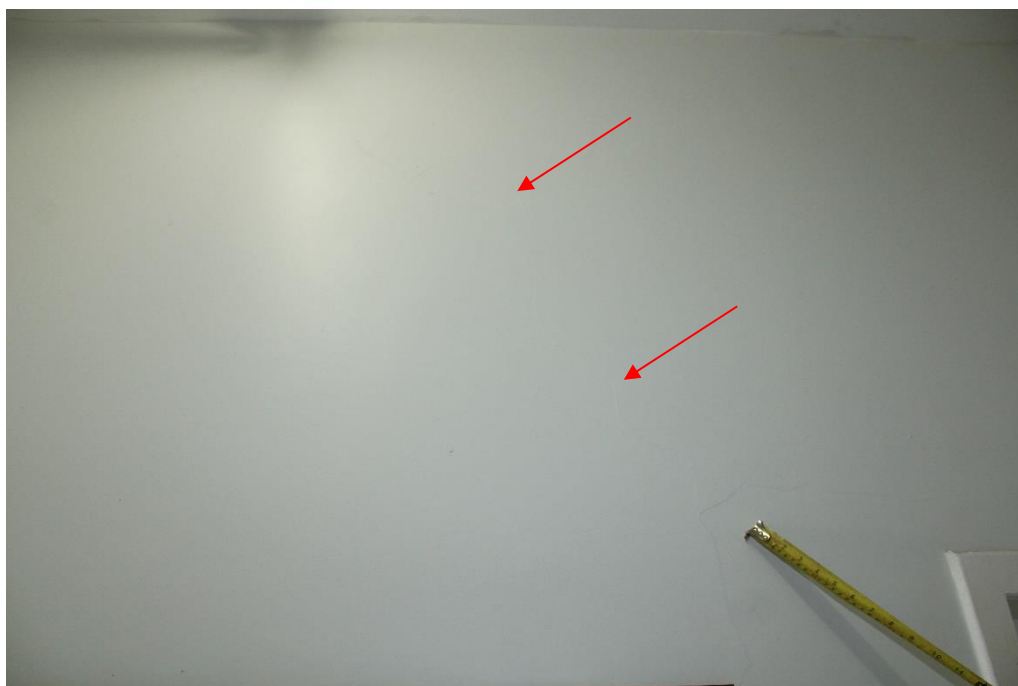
Em detalhe a Foto acima, destacando sinais de correção de fissuras.
